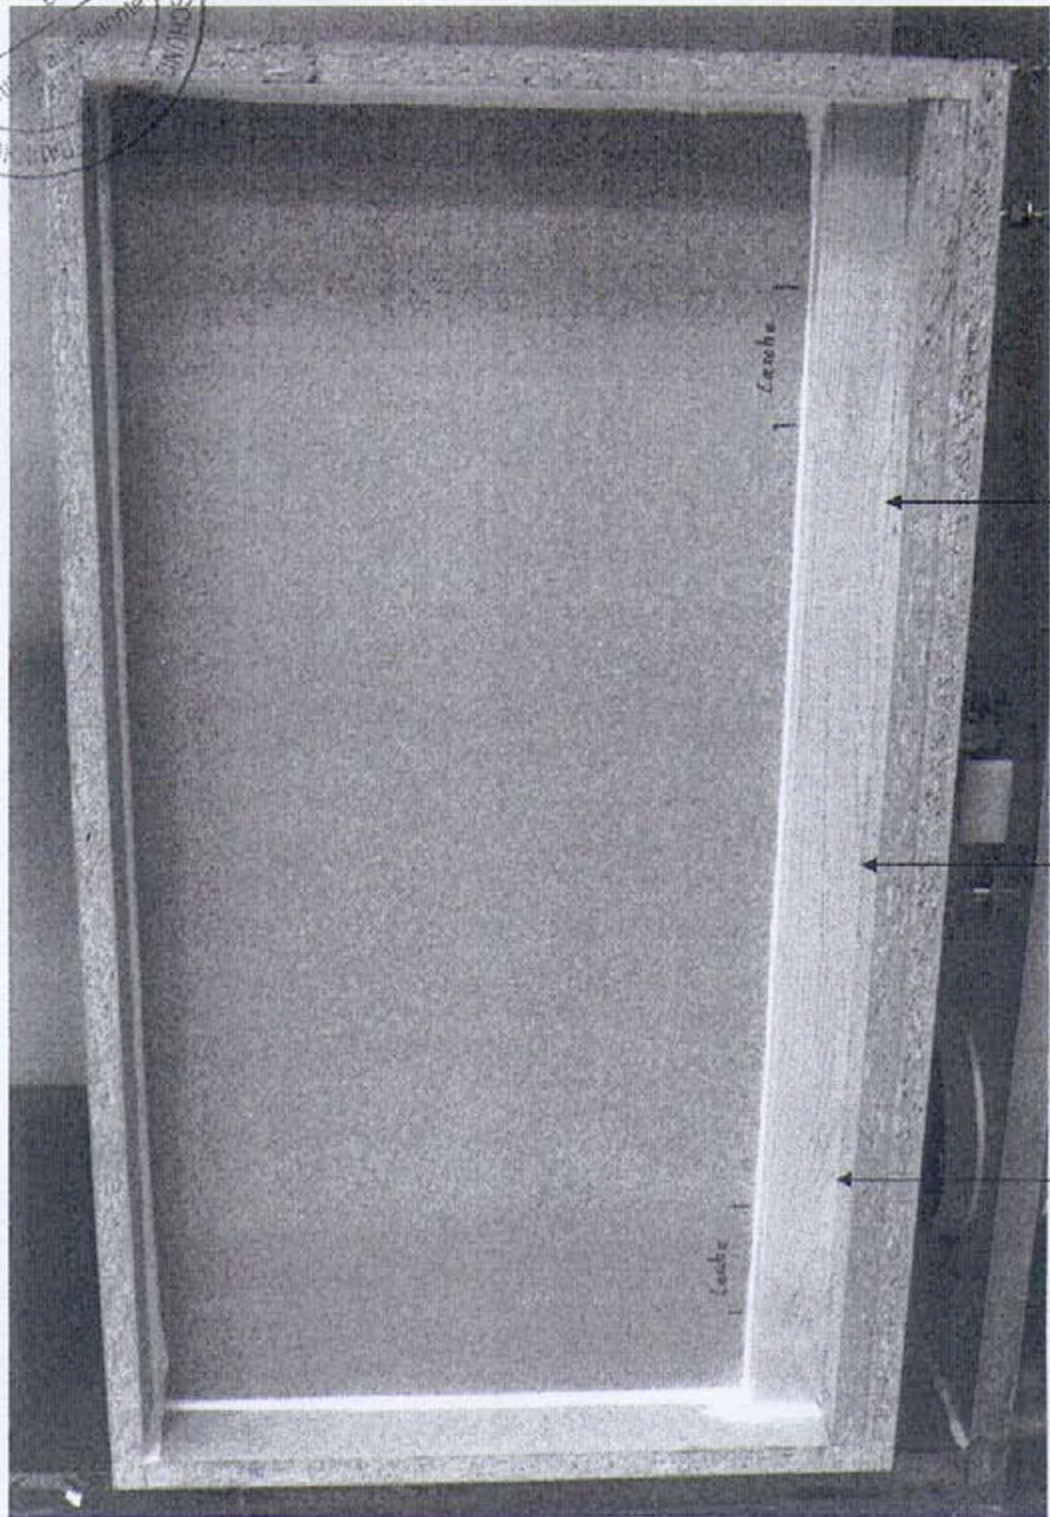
Fotografische Darstellung eines Probekörpers mit Fugenfüllung „Würth PURlogic FLEX“-Montageschaum zwischen simulierter Wand und Fensterrahmen, mit Rahmenbefestigungslaschen. Der Montageschaum wird durch eine Leiste mit 2 mm Spalt zur geschäumten Fuge verdeckt.
